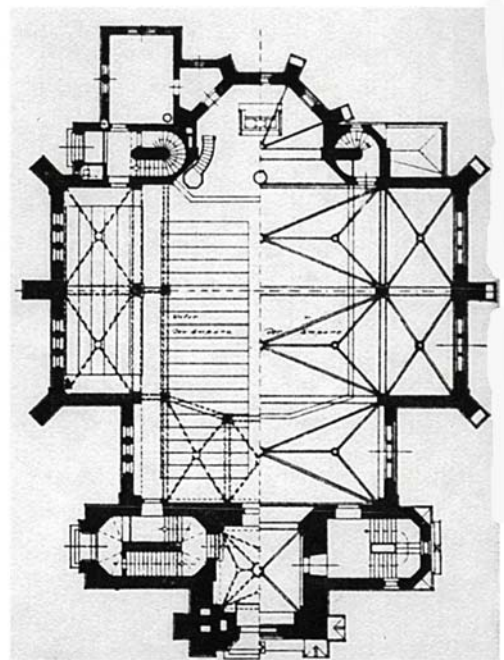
Grundriss Erd-/Emporengeschoss
